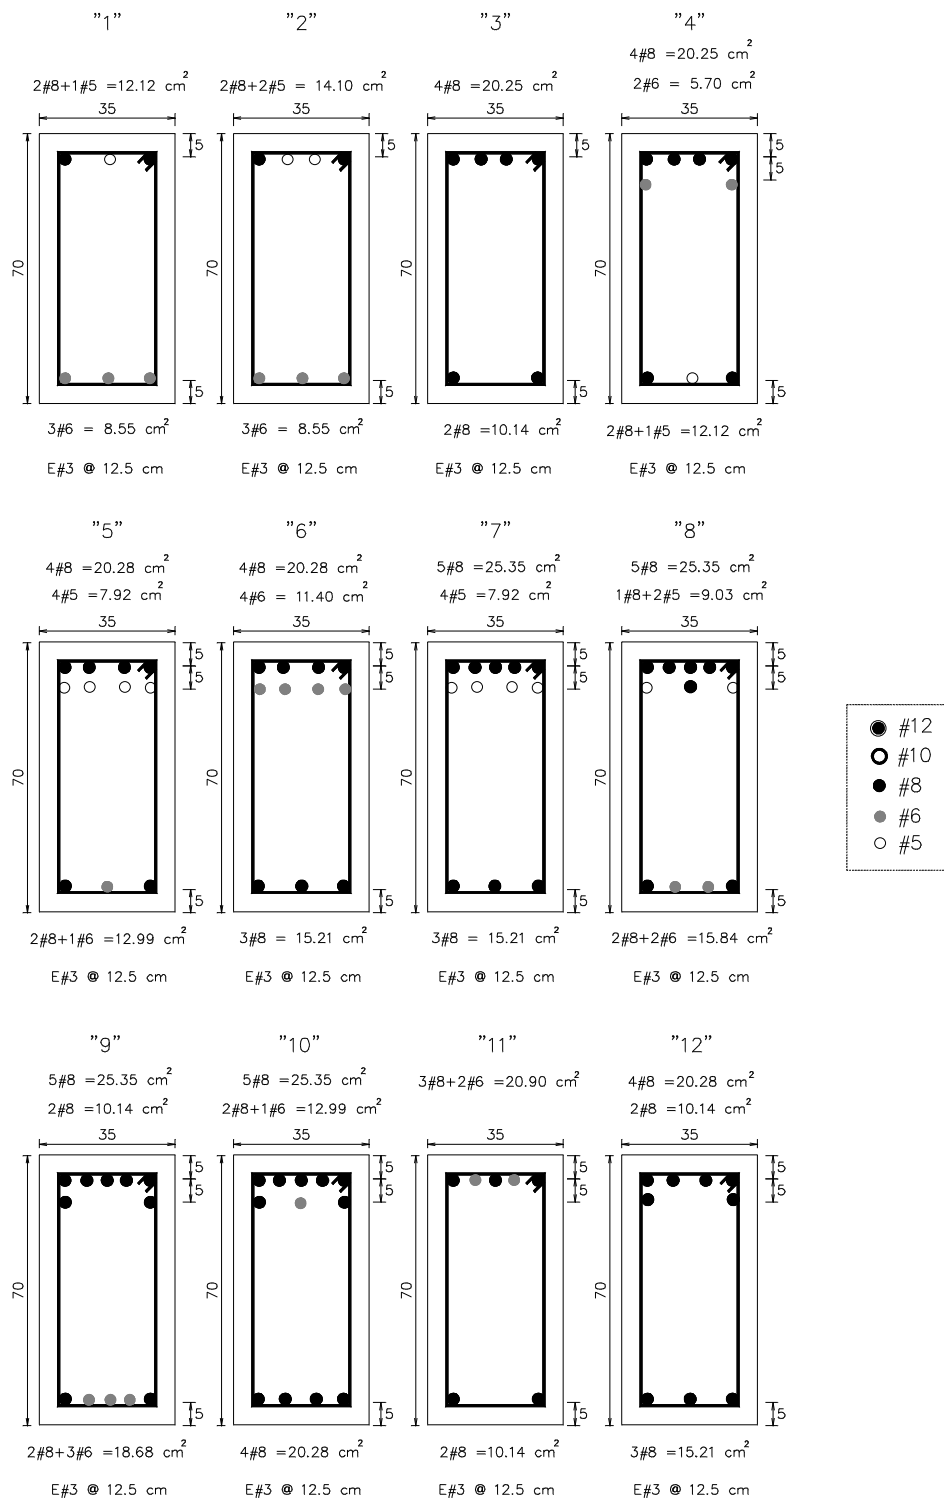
Tipos de armados propuestos para las vigas del eje 2, estructuras de 7 niveles diseñadas en zona III (RDF-93 y RDF-04)
